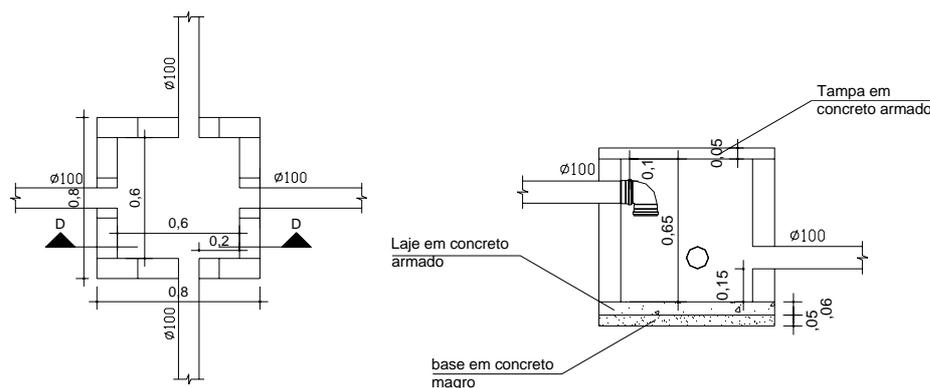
Planta baixa da caixa de distribuição do efluente proveniente da fossa séptica e corte DD da caixa de distribuição do efluente proveniente da fossa séptica. *Dimensões em metros (m).
